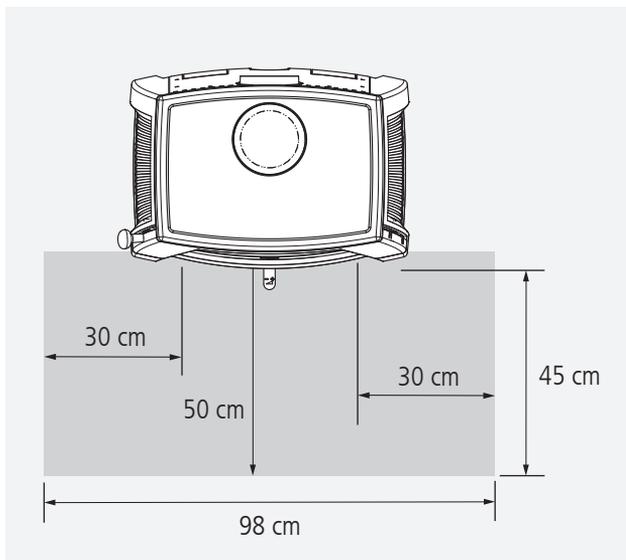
Revêtement incombustible devant la porte de la chambre de combustion de l'APELLA small
